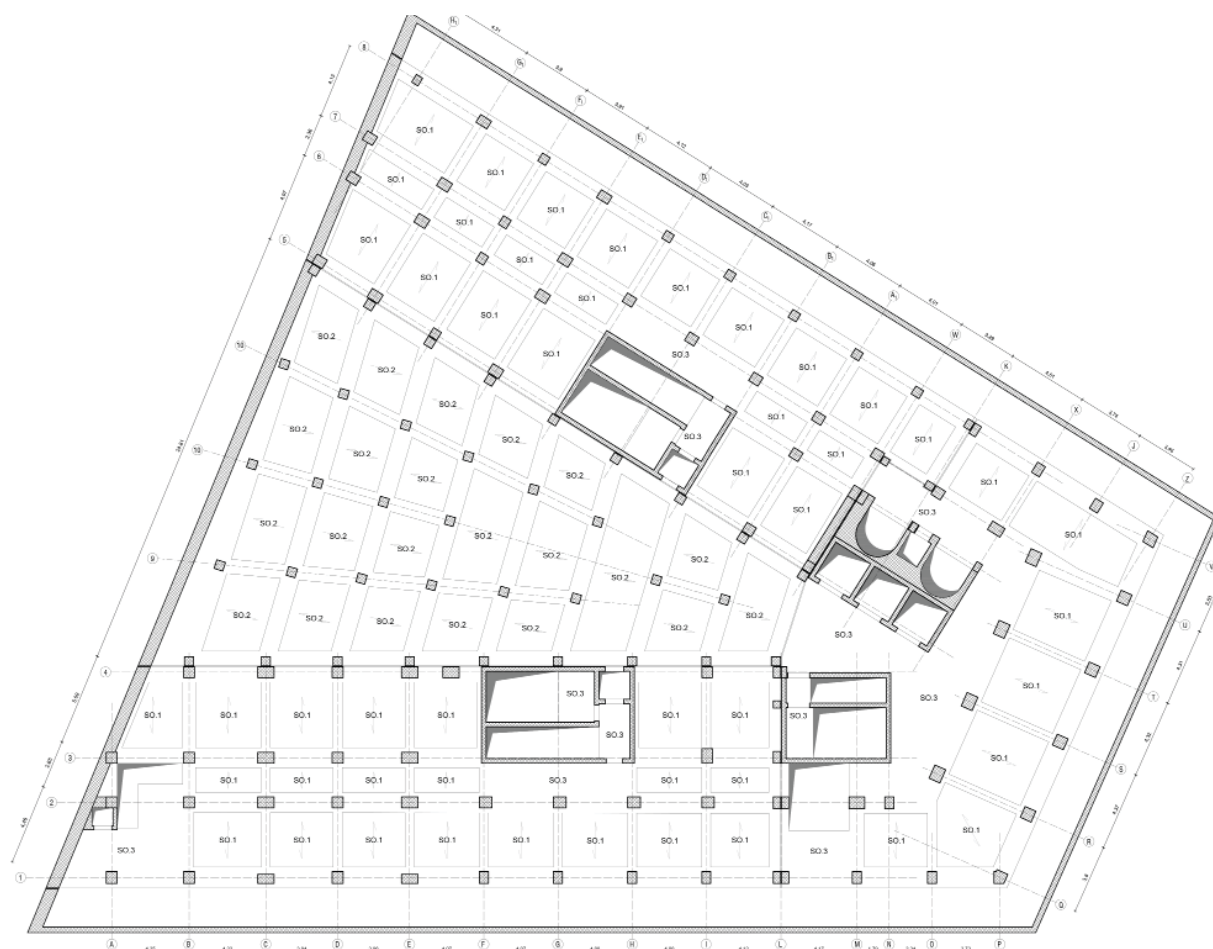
Pianta tipo strutturale impalcata da primo a settimo
